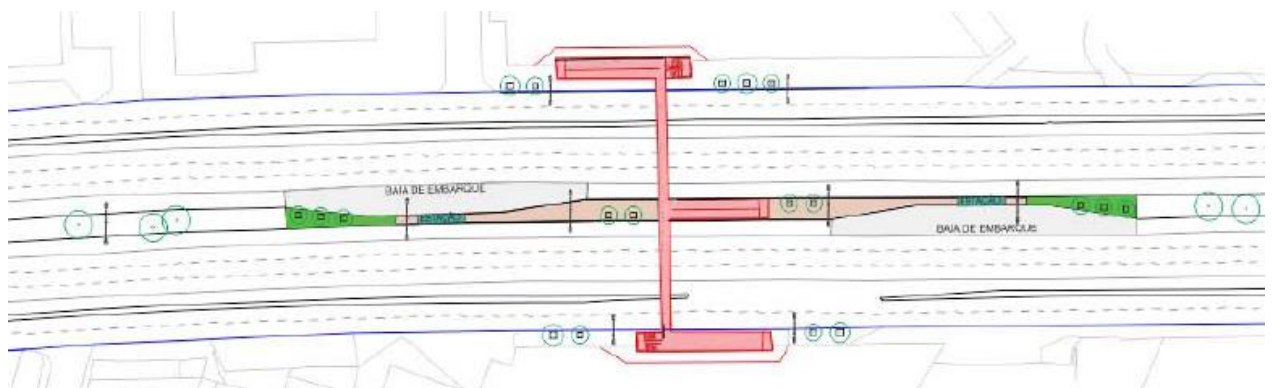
Planta Baixa Plataforma - Fonte: SEINF.
